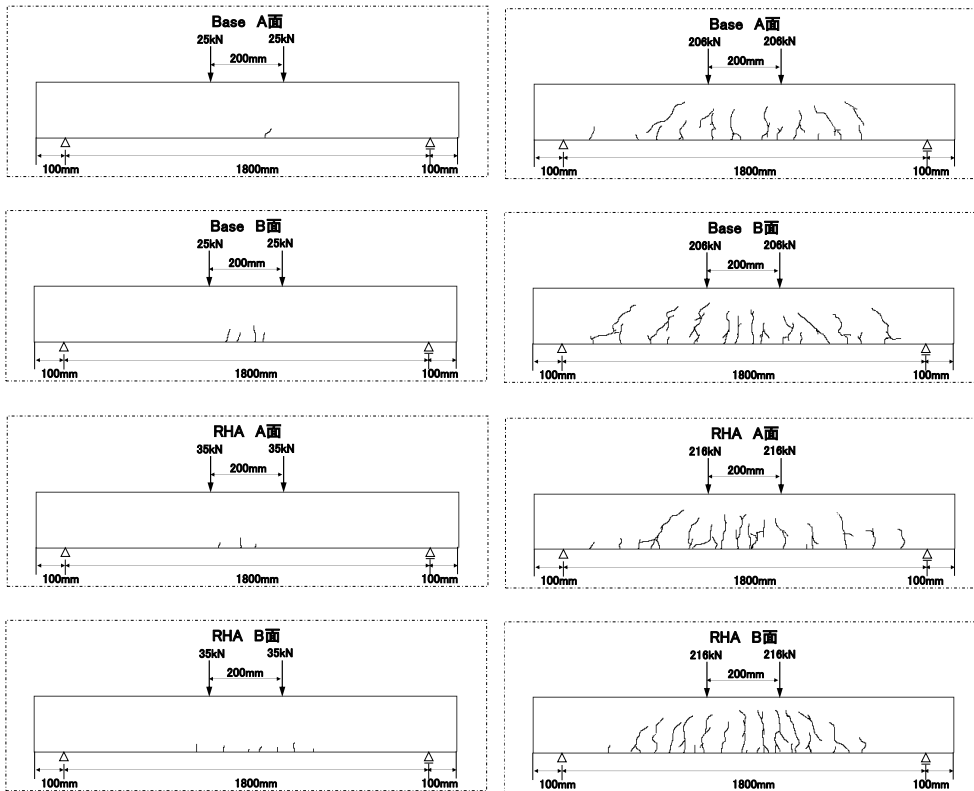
RC 梁ひび割れ発生時の状況
